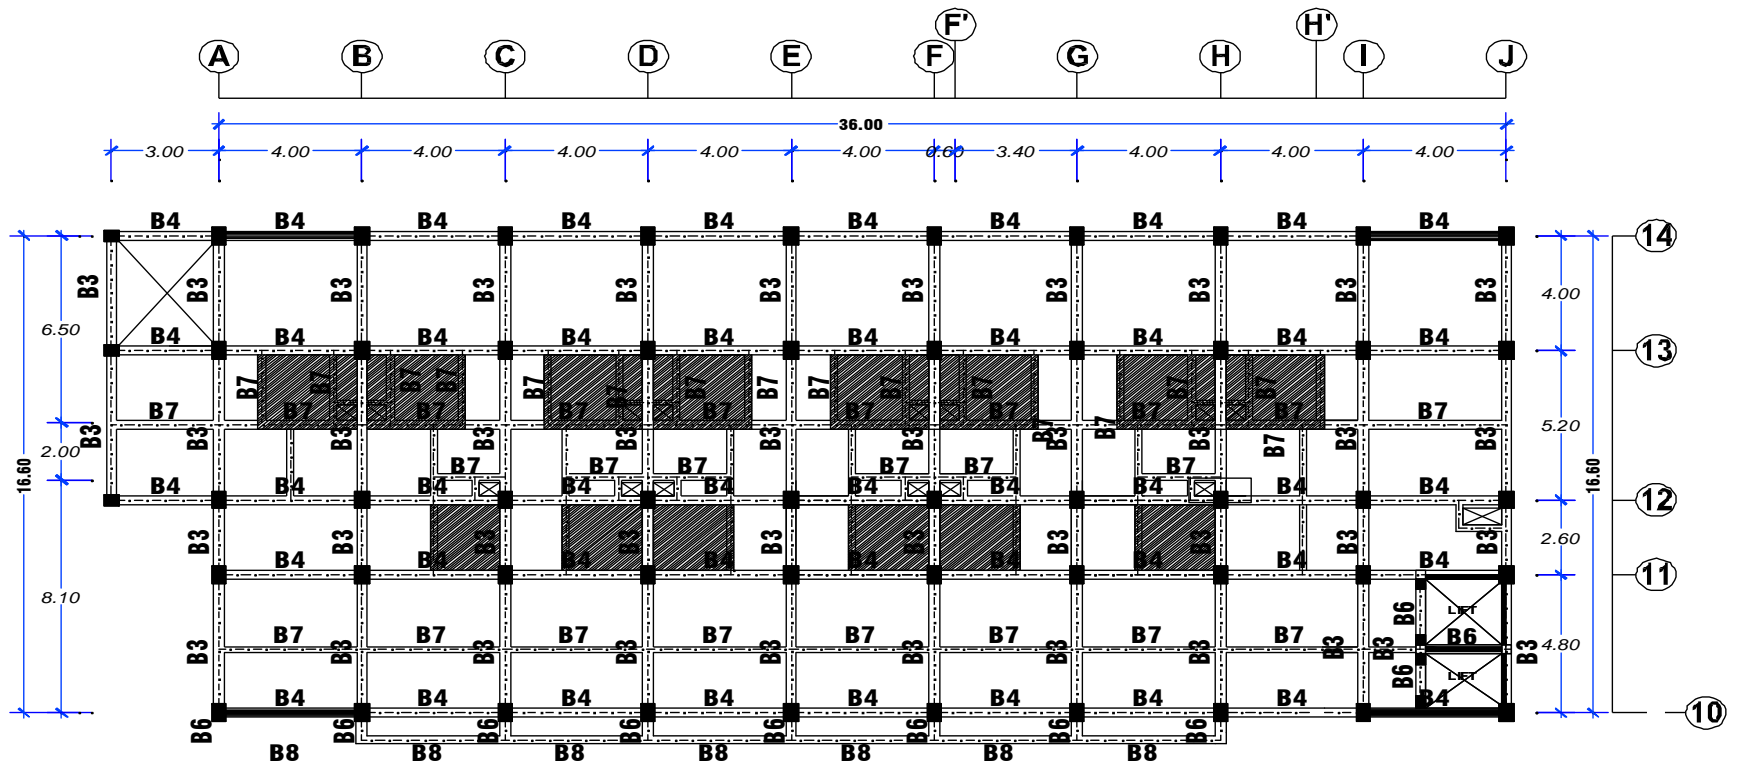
Denah Kolom Lantai 1 / Line 10-14
